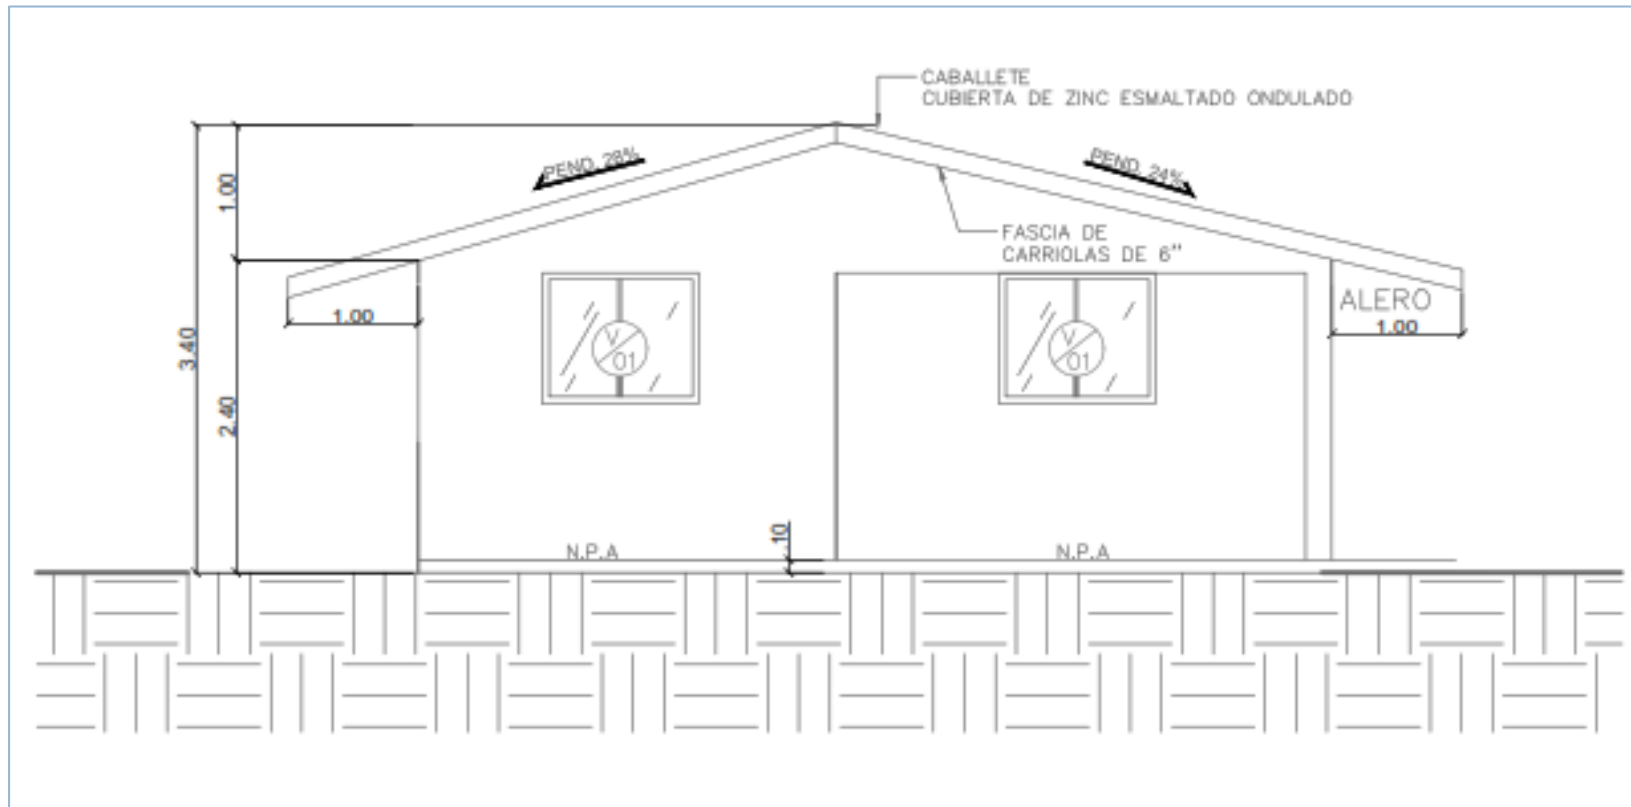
Elevación Frontal de las casas. Fuente: Plano arquitectónico
